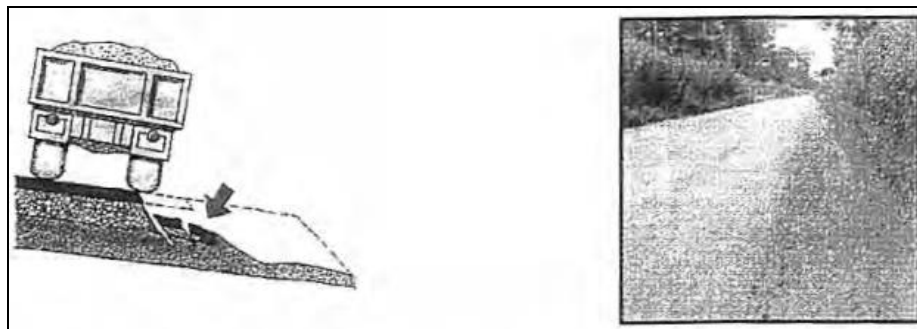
et photo 1.7 : Epaufrure sur chaussée souple [6].
